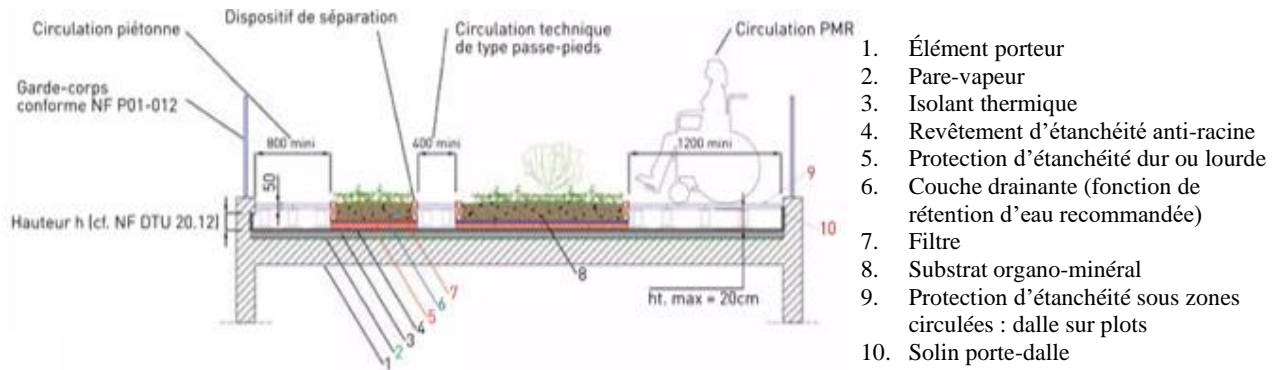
Coupe schématique de plates-bandes : accessibles au public
